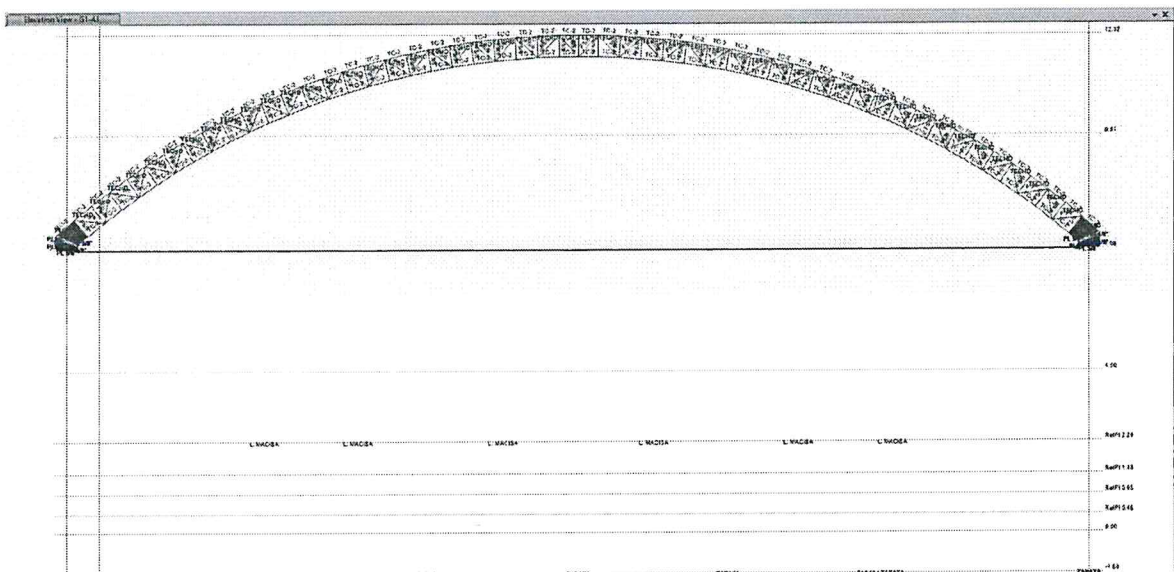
Vista en Elevación del modelo estructural de la Edificación 19-20 sistémico analizado. Los elementos no estructurales fueron ingresados como cargas permanentes
